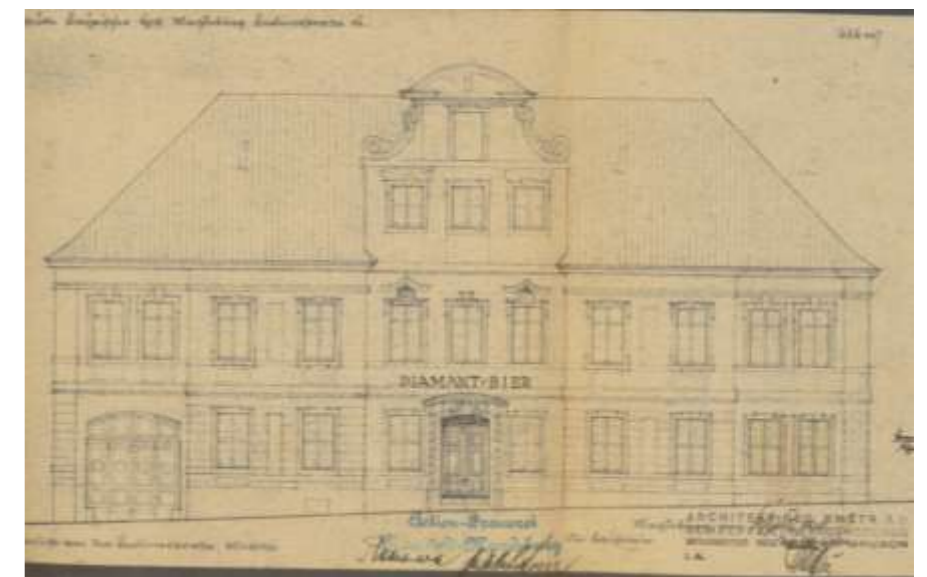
Fassadenaufriss der ehemaligen Brauerei Bayerischer Hof in der Berliner Straße 14 (Bauaktenarchiv, Akte 1172 Z)
